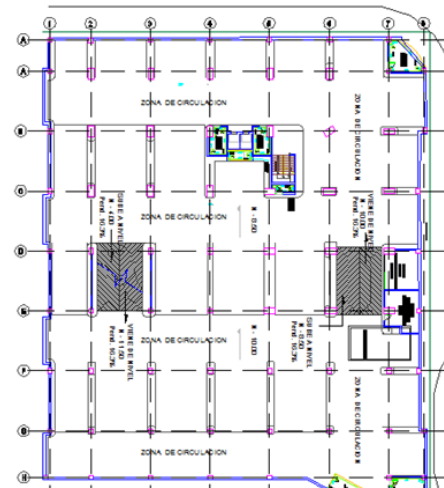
Planta arquitectónica Sótanos 1, 1ª ,2, 2A
